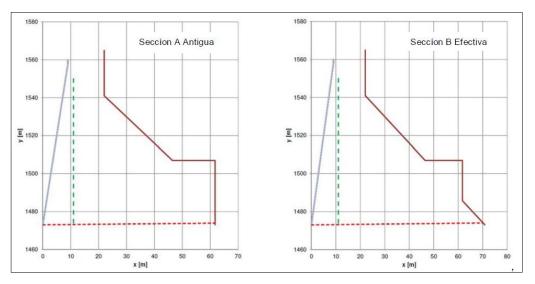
Esquema de las dos geometrías de los bloques centrales. (Fuente: CRM)
